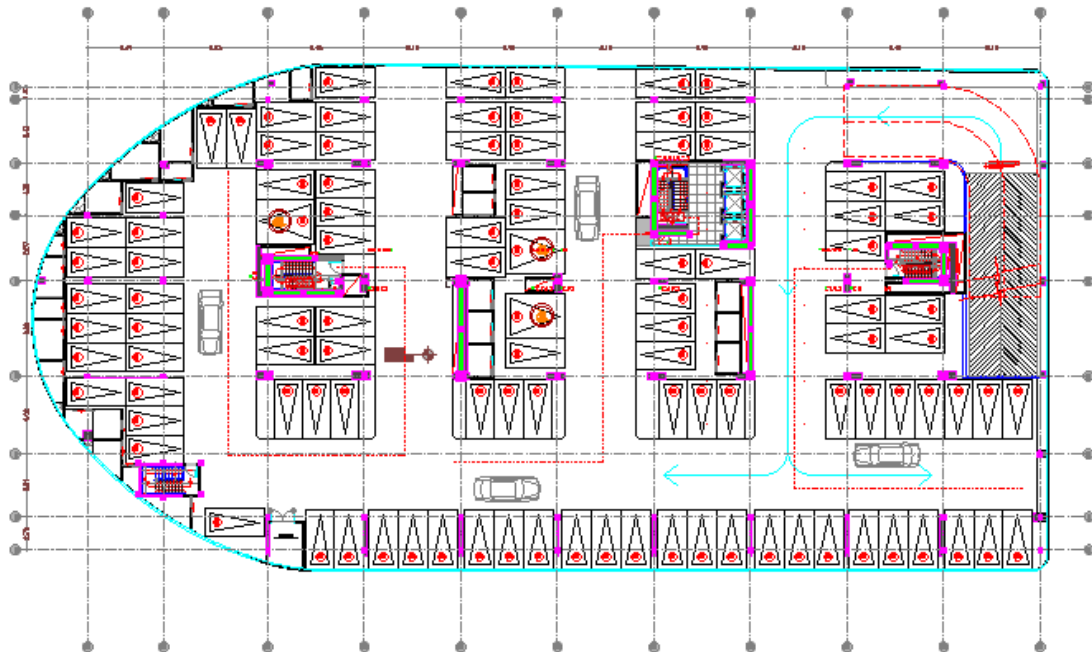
Planta de aparcamiento piso dos, columnas (lila) y arriostramientos (verde).
